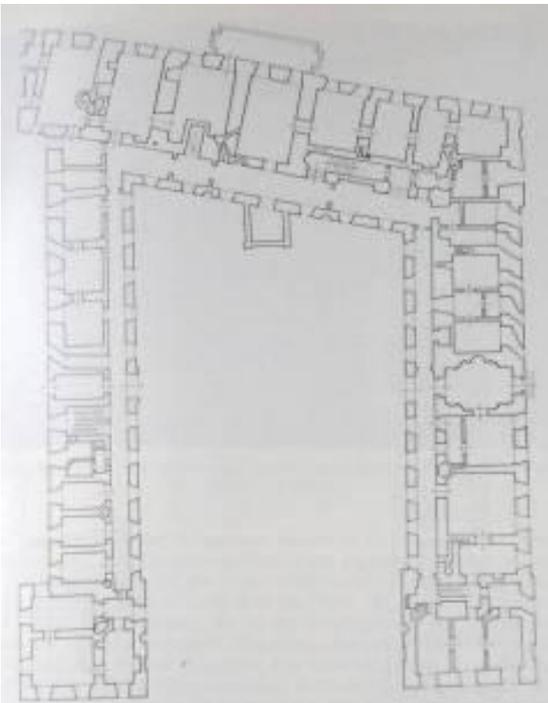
Schloss Esterházy, Grundriss (EG)
